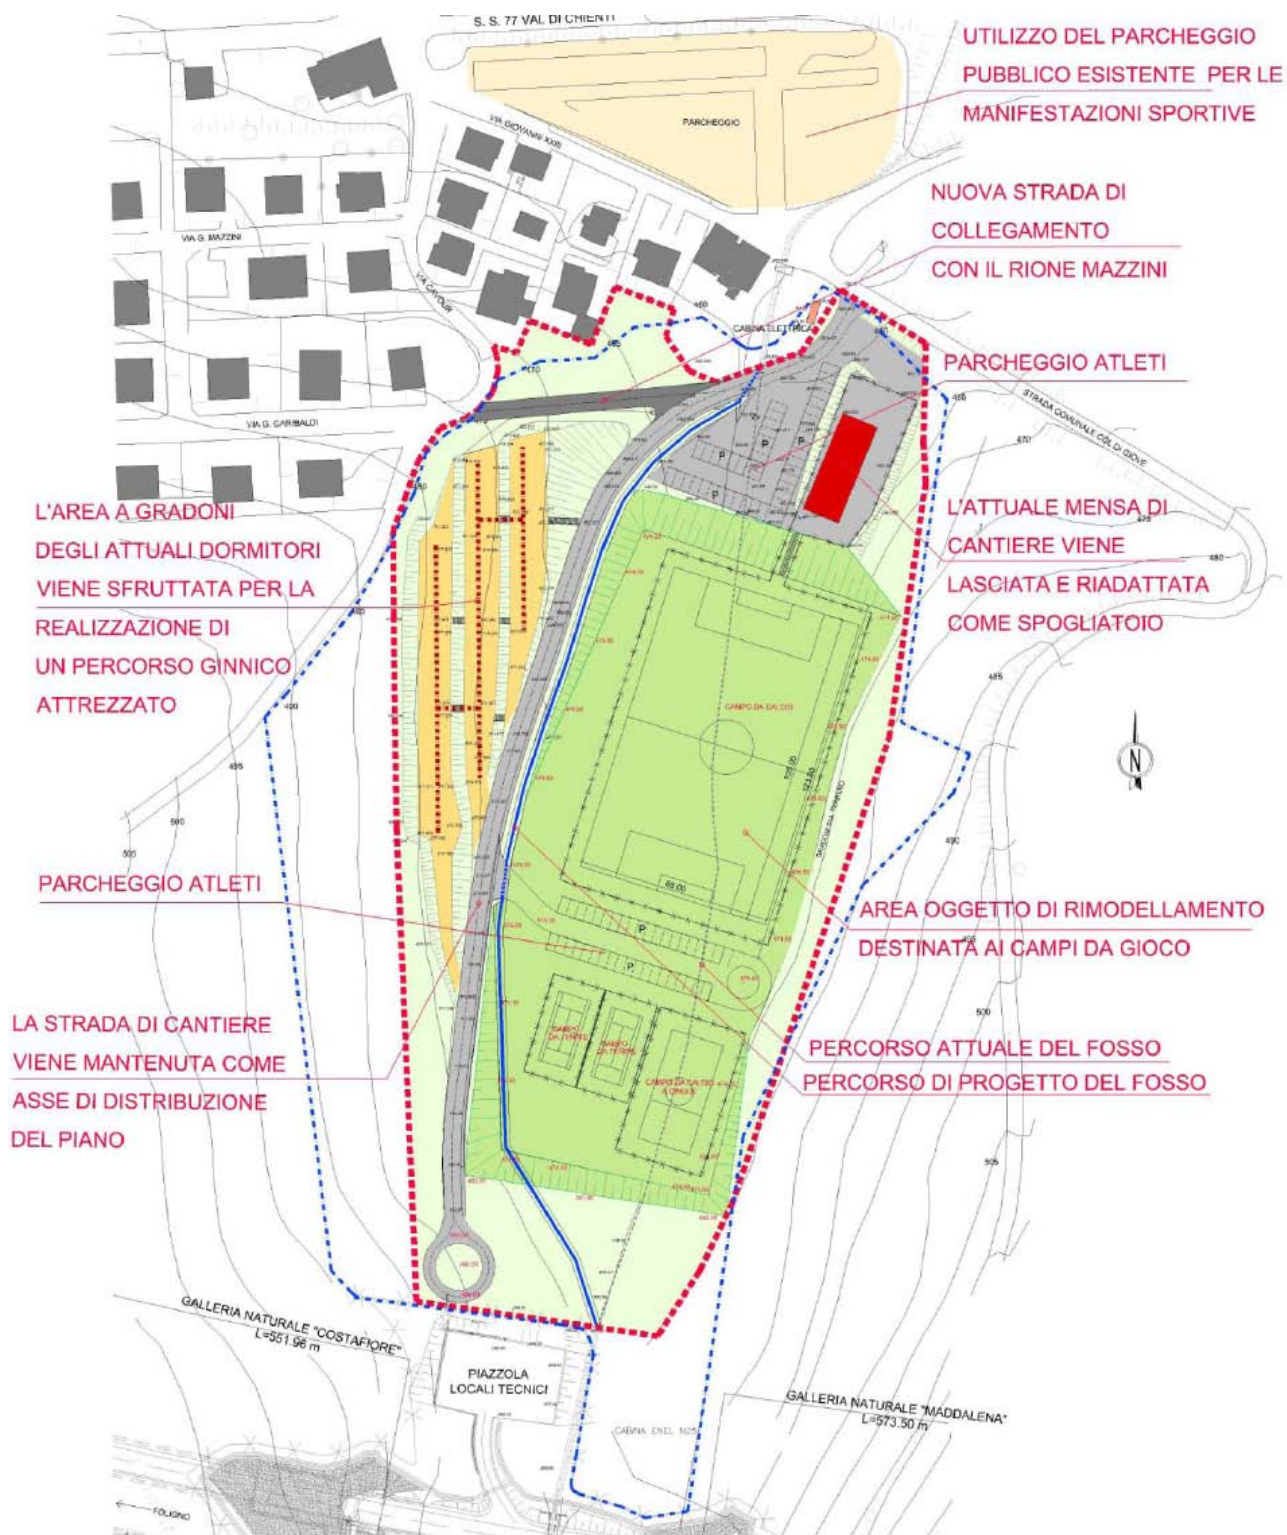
Stralcio planimetrico del Piano Insediamenti Impianti Sportivi
